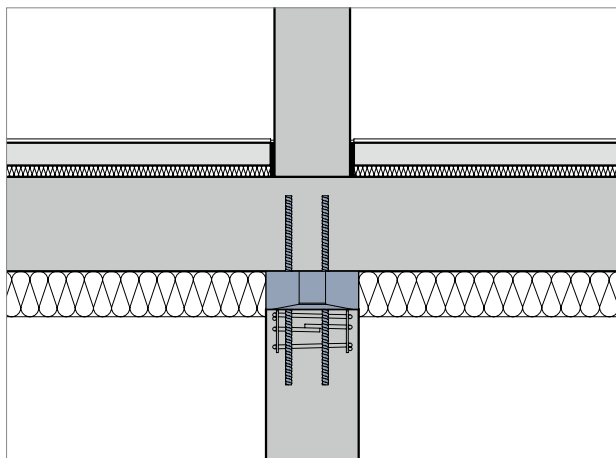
Zobrazení dvou rovin řezu pro stanovení $\lambda_{eq,prům}$ detailu napojení stěny, s bodově umístěným prvkem Schöck Sconnex® typ W a tepelnou izolací mezi prvky
